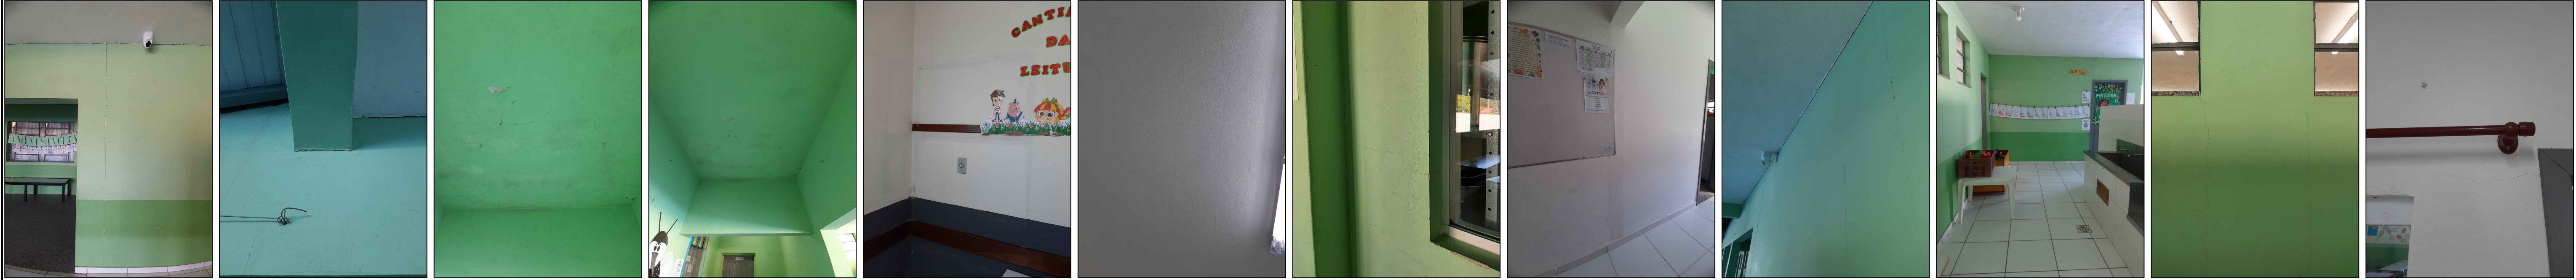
FOTO 74 FOTO 75 FOTO 76 FOTO 77 FOTO 78 FOTO 79 FOTO 80 FOTO 81 FOTO 82 FOTO 83 FOTO 84
